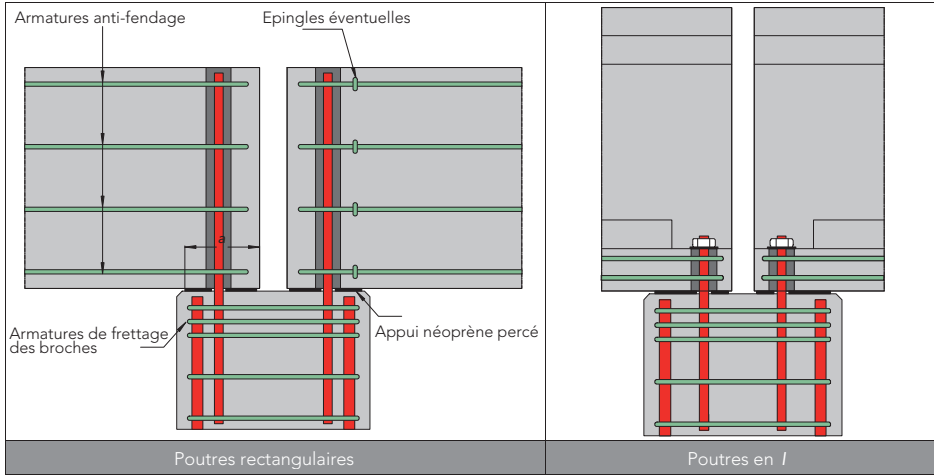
Exemple de détails d'assemblage poteaux-poutres.
